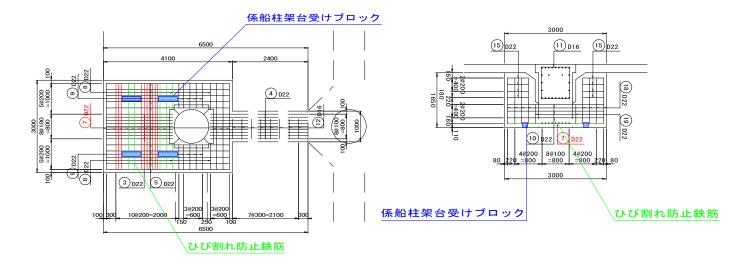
係船柱架台受けスペーサー配置図(左:正面図、右:平面図)
